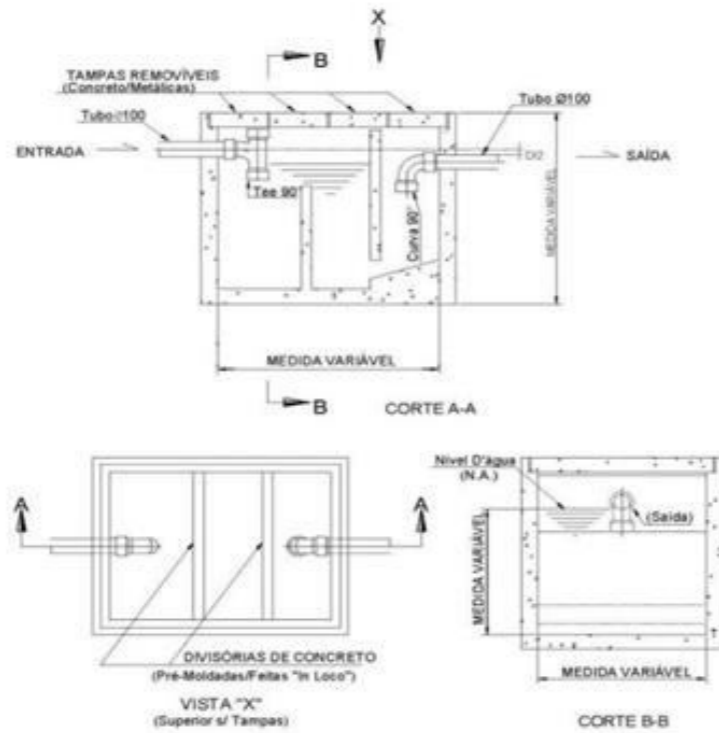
Modelo de Ligação de Esgoto - Detalhe 2.
